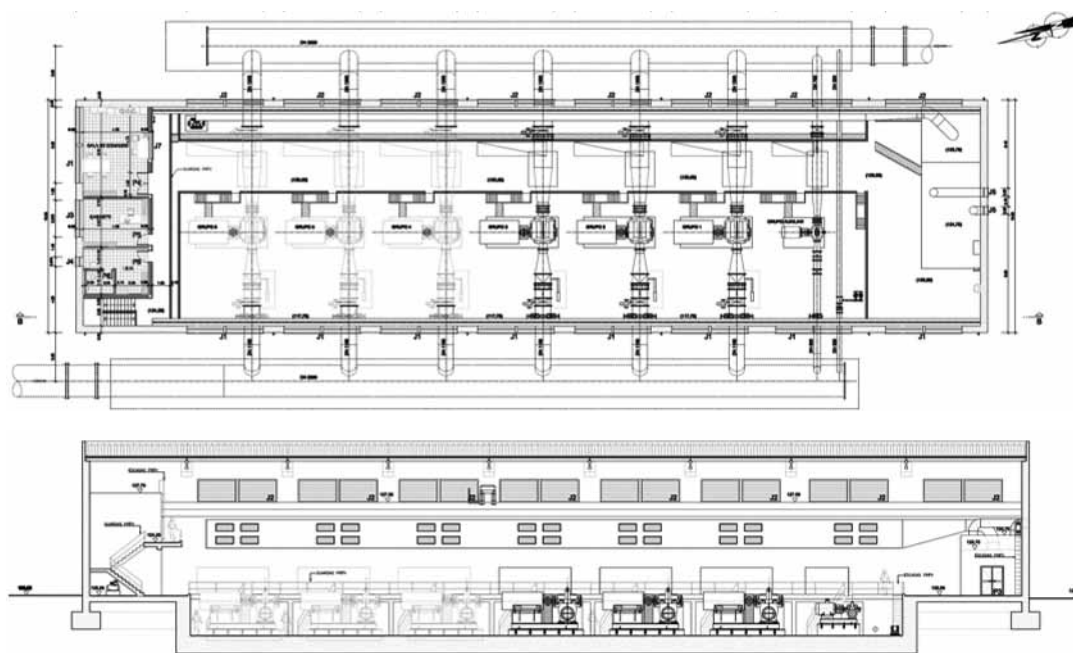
Central da Amoreira. Planta e Corte Longitudinal
